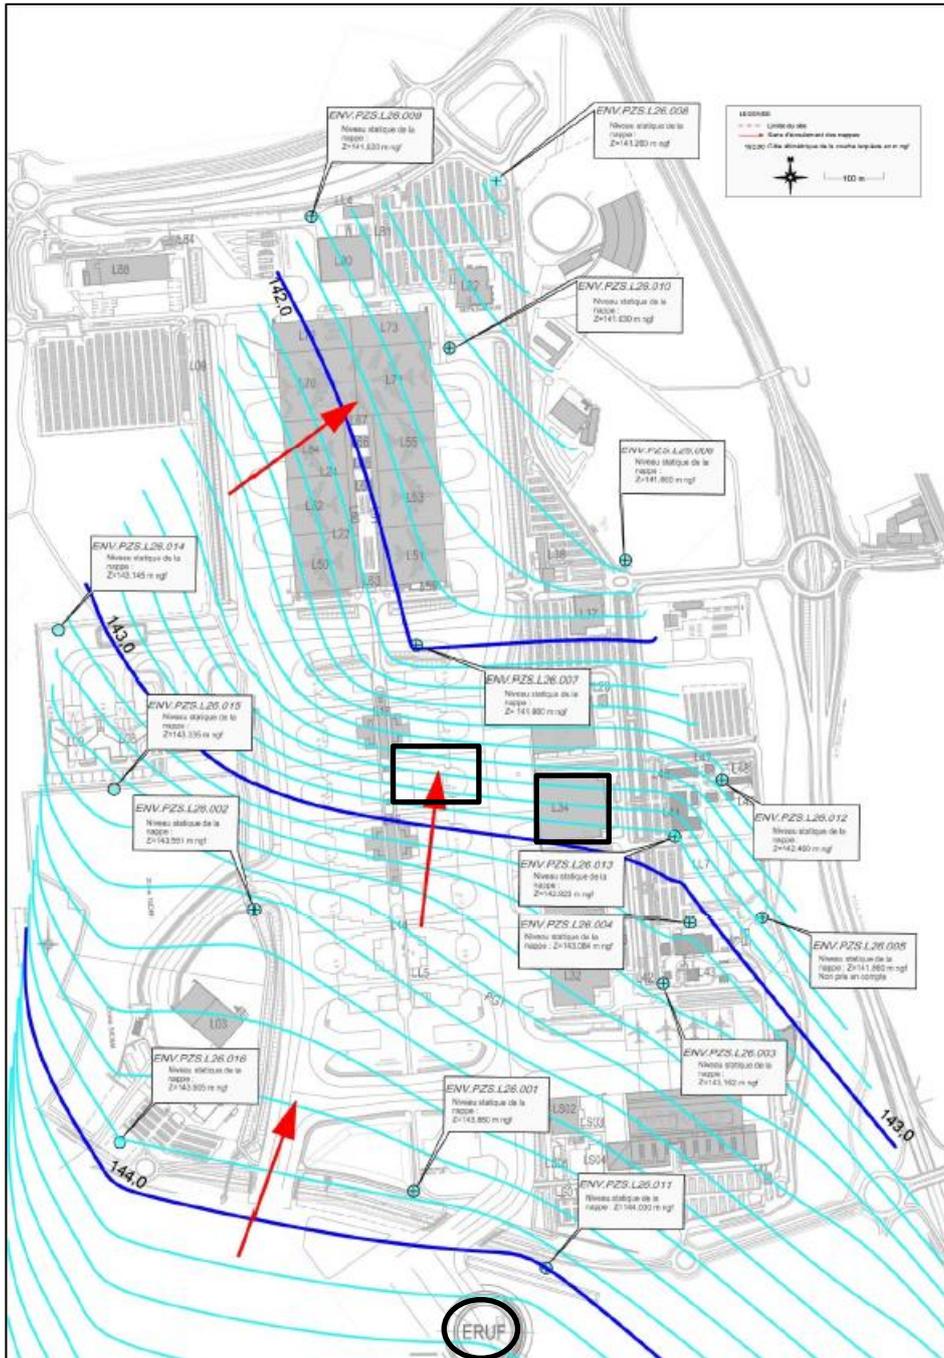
Plan d'implantation des piézomètres sur le site Jean-Luc Lagardère – localisation du projet en noir
